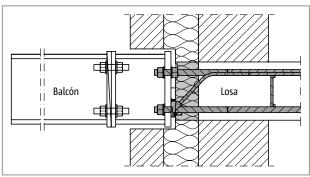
Schöck Isokorb® T tipo SK: Elemento aislante dentro del núcleo aislante; el conector in situ entre el Isokorb® y el balcón proporciona flexibilidad en el proceso de construcción
